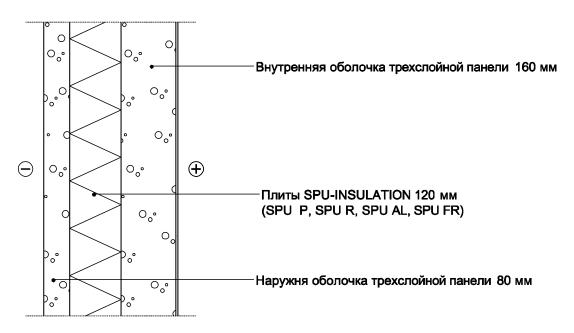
Разрез трехслойной стеновой железобетонной панели
